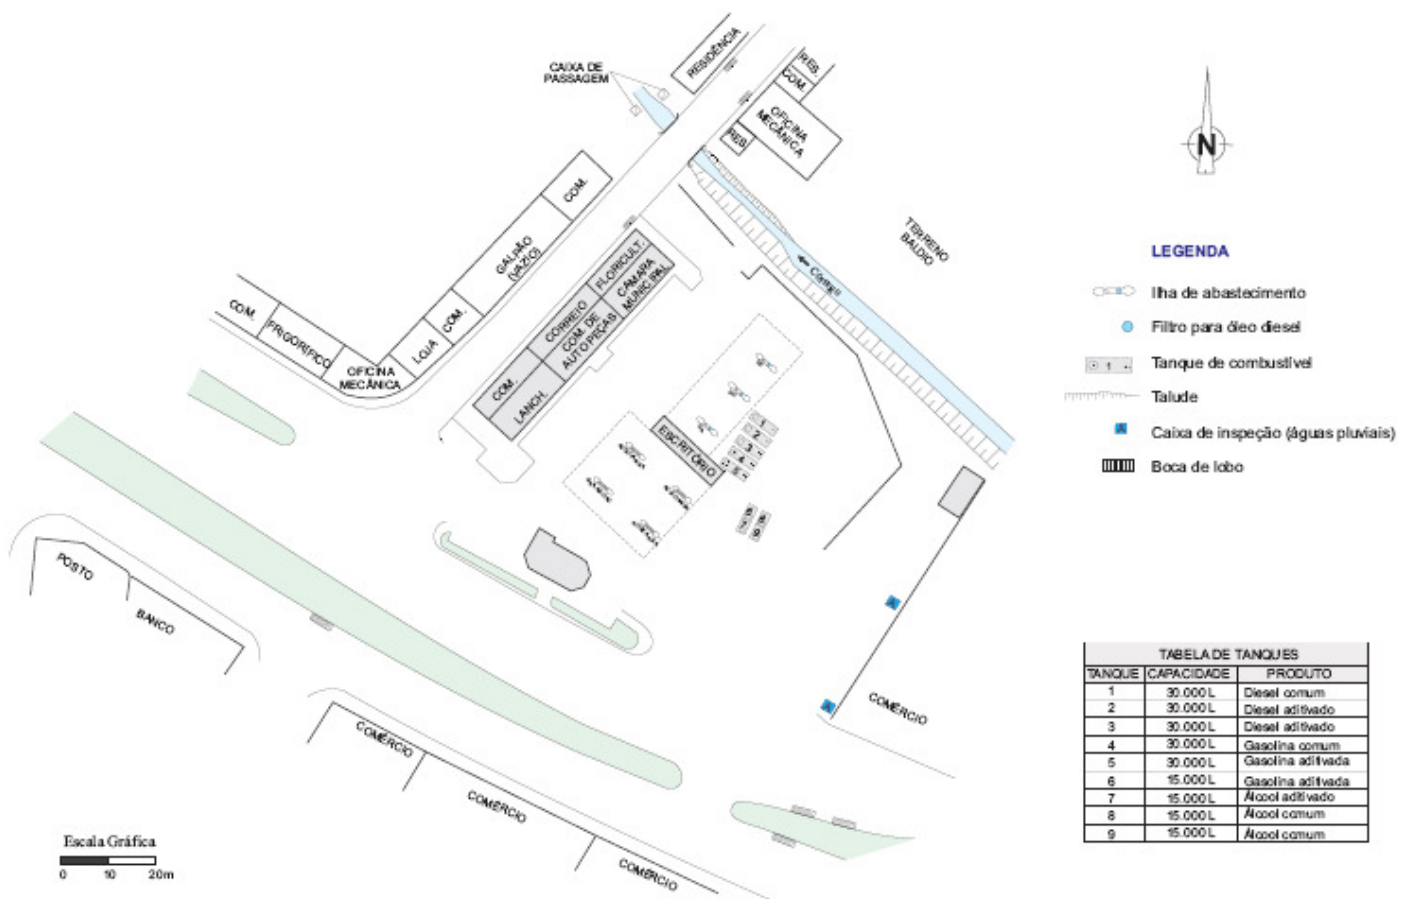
Arranjo físico das instalações do posto e arredores (Fonte: adaptado de GEOKLOCK, 2000)
